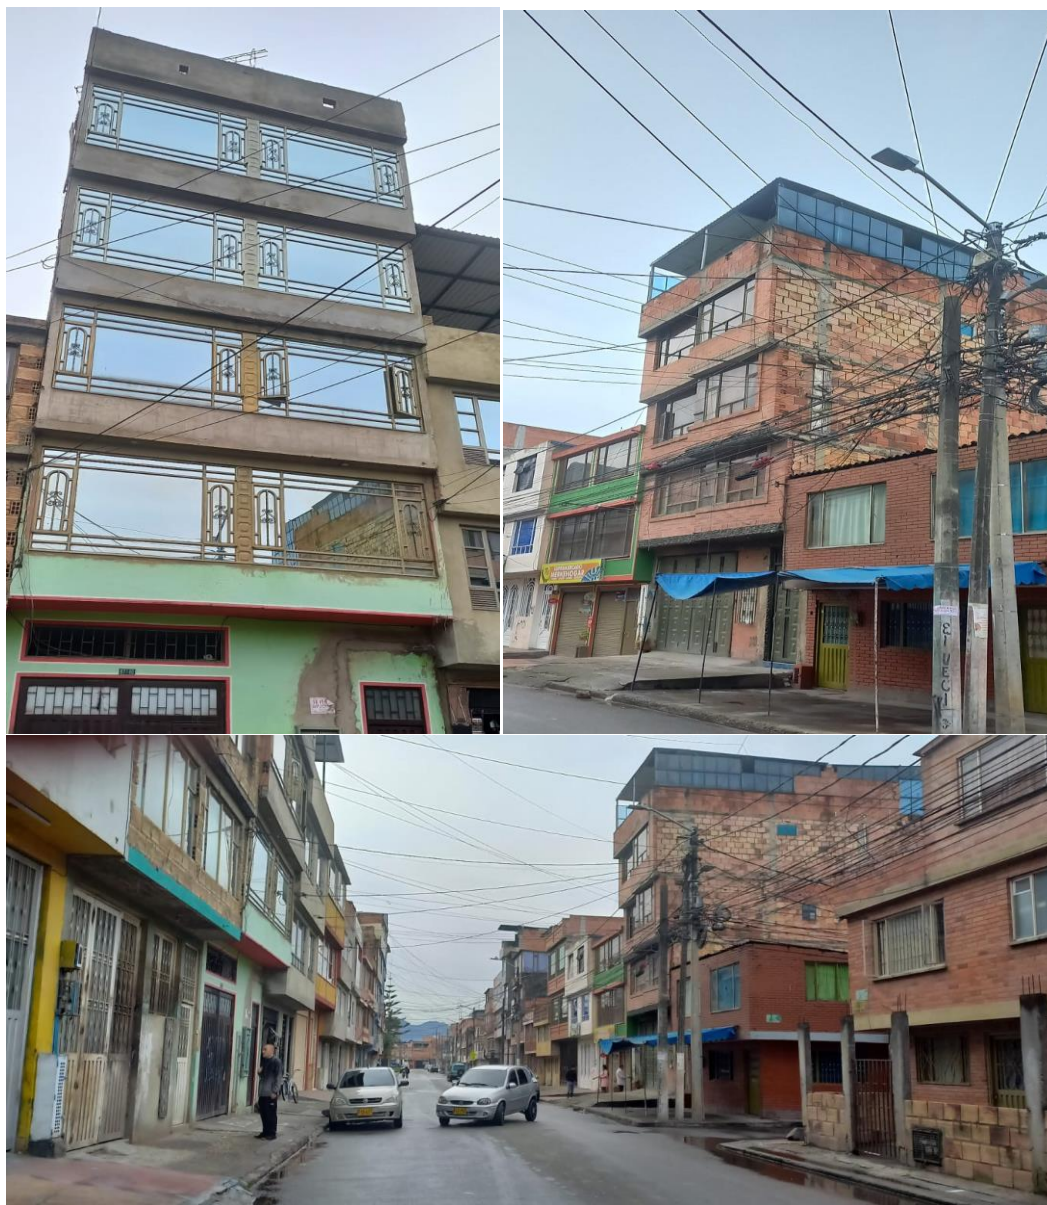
Viviendas con construcción Mixta; Pórticos- Mampostería sin confinar sector Patio Bonito
